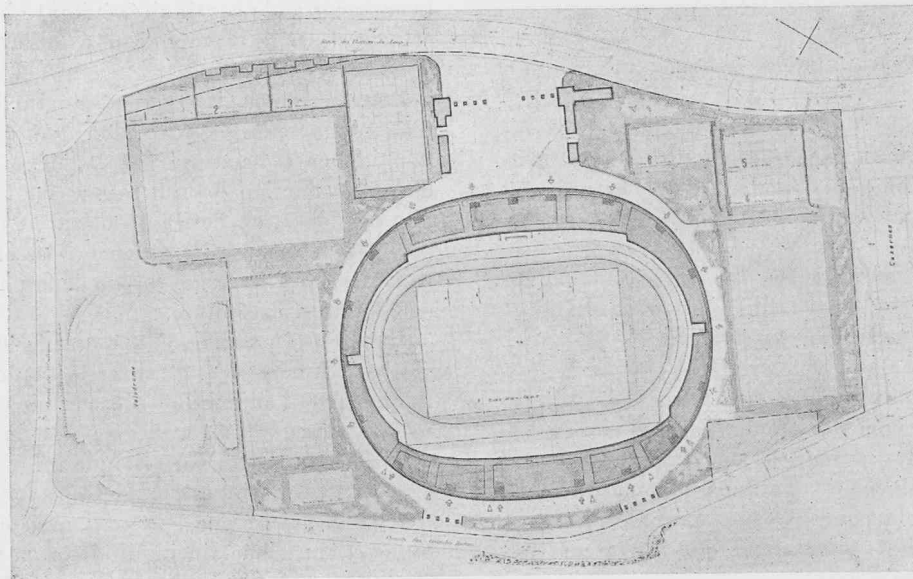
Plan général de situation. — Echelle 1 : 4000.
